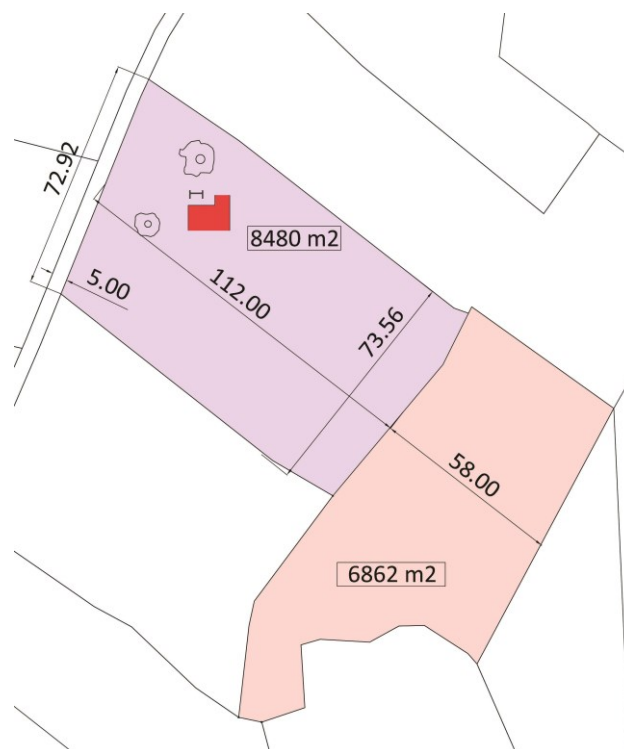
Plano parcela y ubicación de vivienda (sin escala). 2016. Editado de PByE
